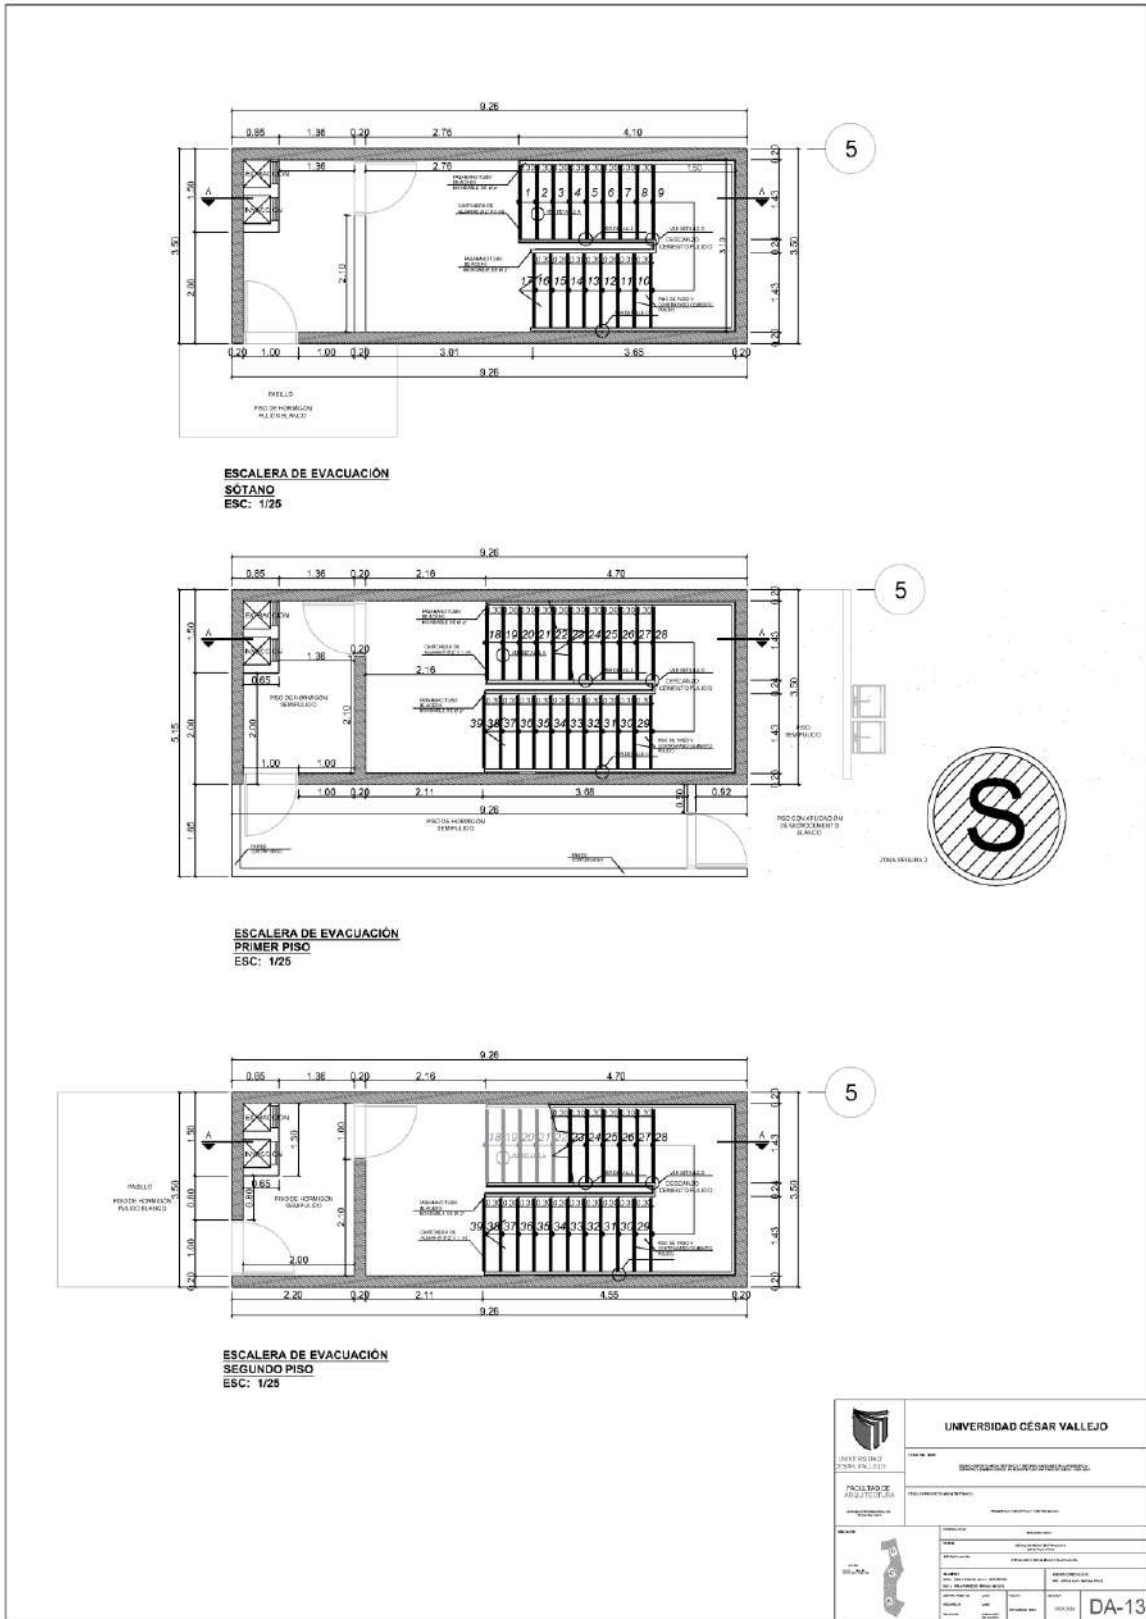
Detalle de escalera de emergencia - DETALLES ARQUITECTÓNICOS
